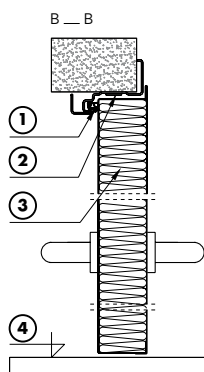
Coupe verticale d'un bloc-porte en tôle d'acier avec bâti angulaire
